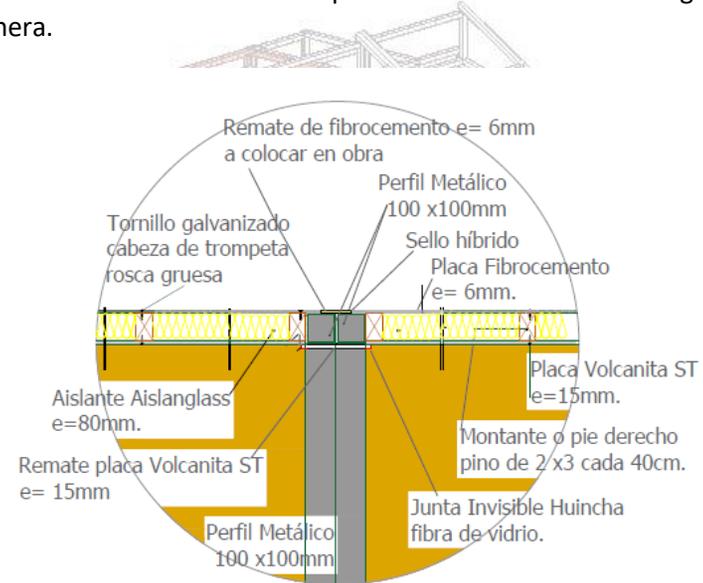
Detalle de solución de tabique de madera con aislamiento de 80mm, yeso cartón de 15mm al interior y de placa fibrocemento de 6mm con chapa grecada o metálica de 0,4mm al exterior.
